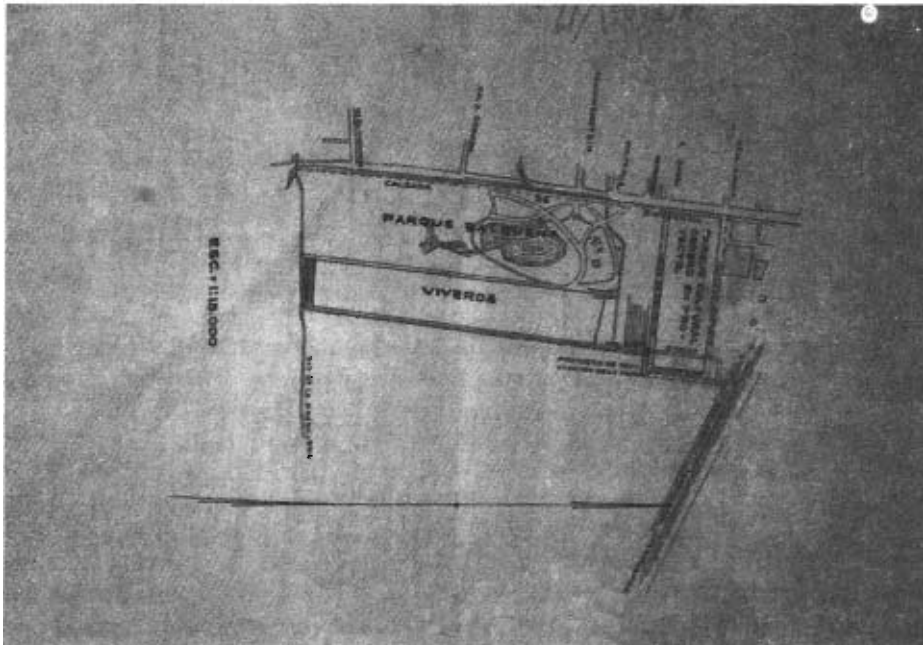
Planta de conjunto del parque Balbuena, hacia 1930. Planoteca del Archivo del Ayuntamiento del Distrito Federal. Sección Parques y Jardines. Planero 1, módulo 1, fajilla 76.
